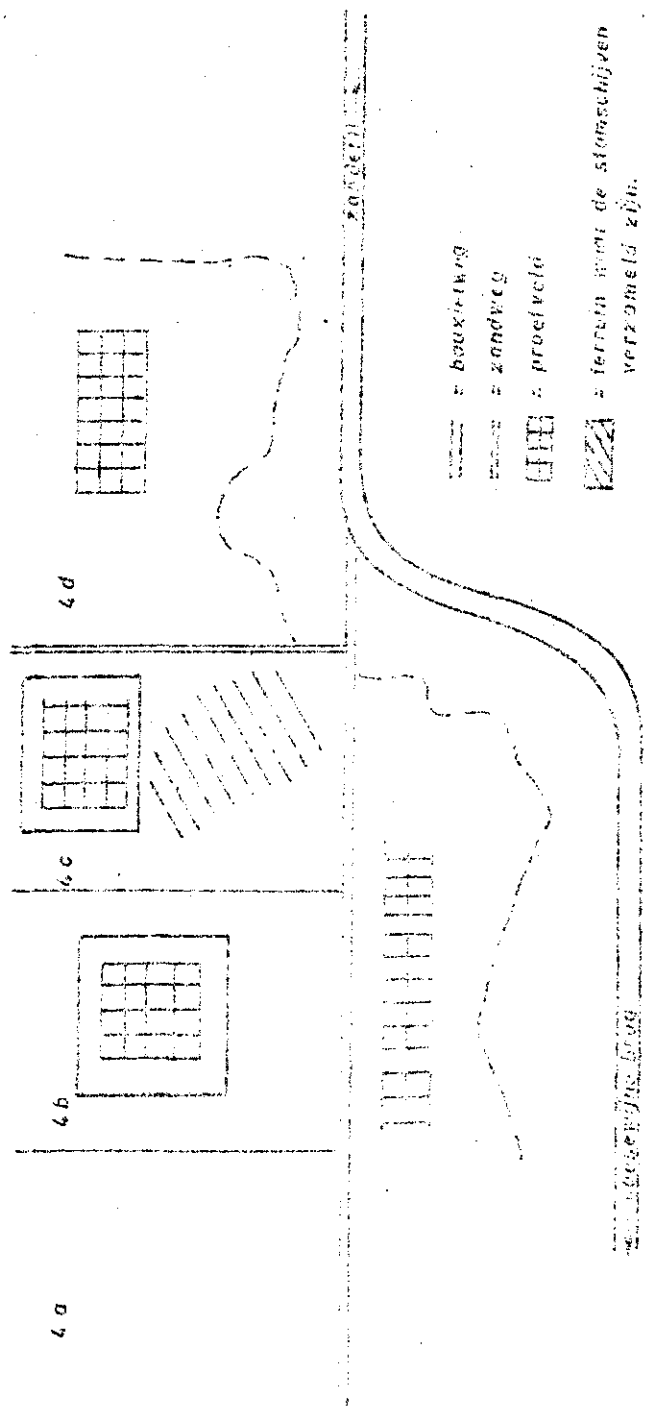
Plan van Stingsluis waar de monters verzameld zijn voor het onderzoek naar de overwelling.
